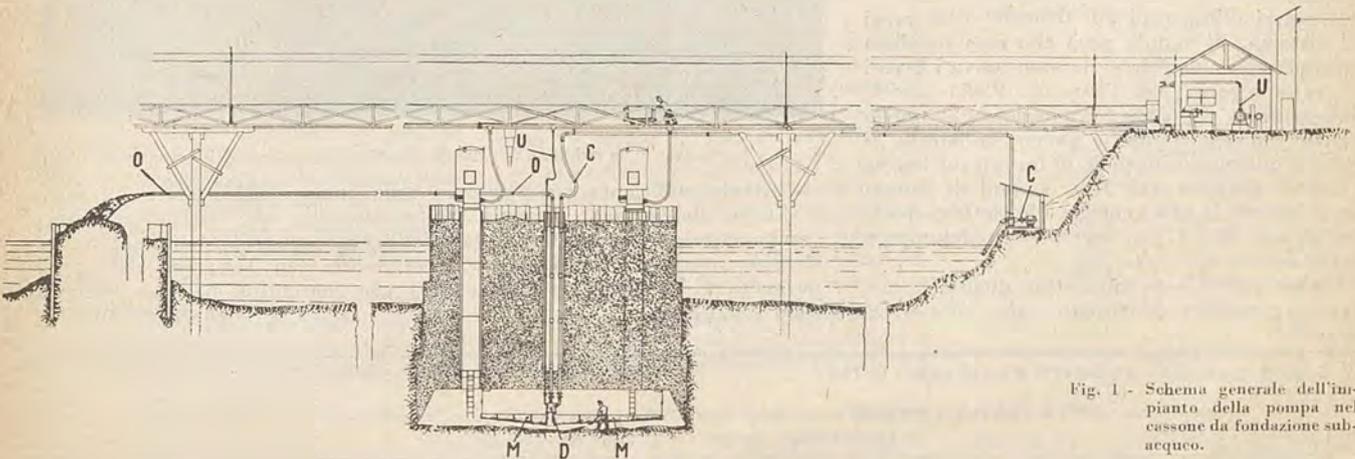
Schema generale dell'impianto della pompa nel cassone da fondazione subacqueo.
